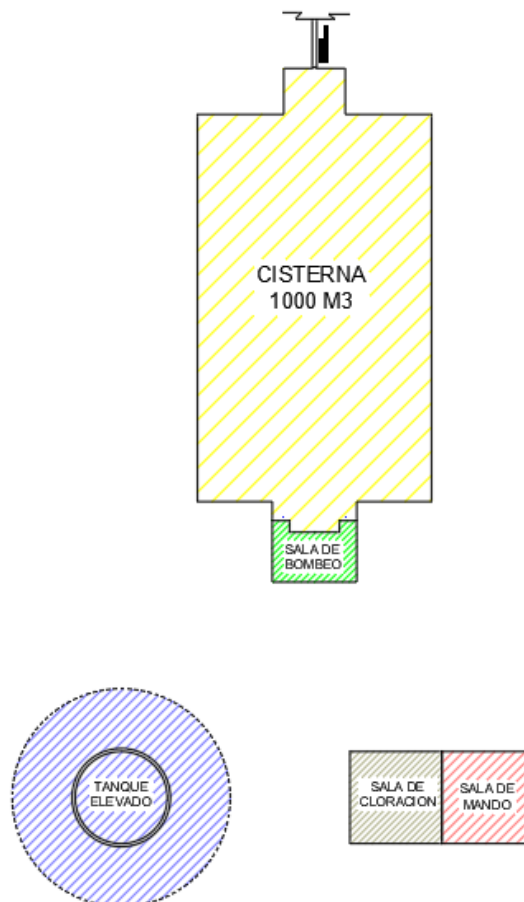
a: Esquema de distribución en planta
